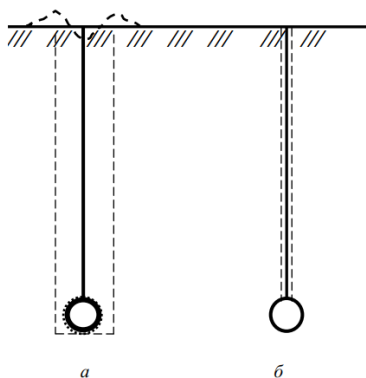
Конструкции дрен: а – трубчатой бестраншейной; б – кротовой
